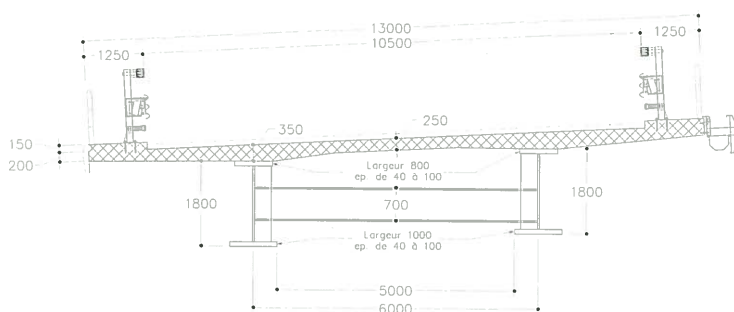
Viaducs Ca' Raniero : Coupe transversale / Deck section
